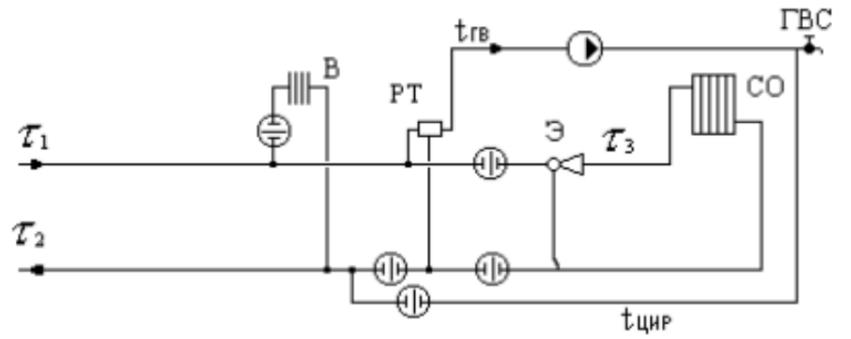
Схема № 6 - Потребитель с элеваторным присоединением СО
